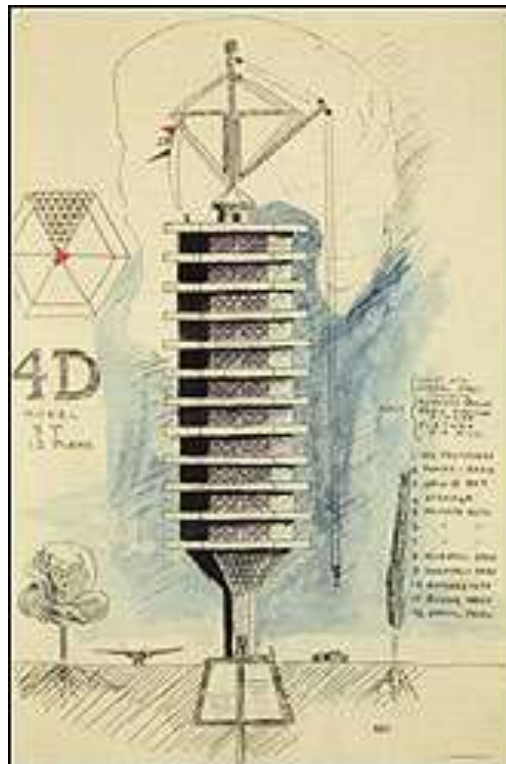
4D Tower 1928. Dibujo de Fuller de una casa 4D Tower nunca construida: doce plantas hexagonales suspendidas de una columna de soporte central.
